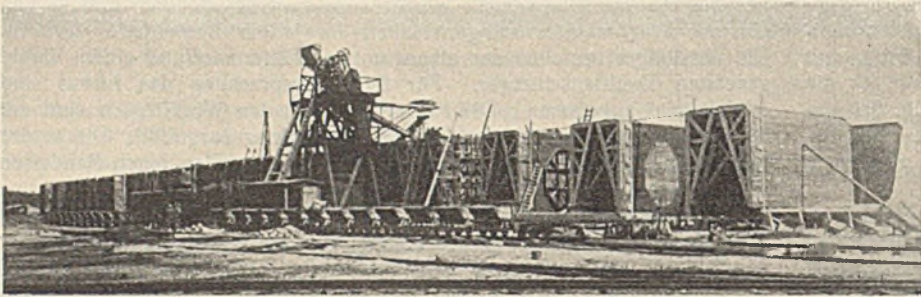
Herstellung der Eisenbeton-Senkkasten.
